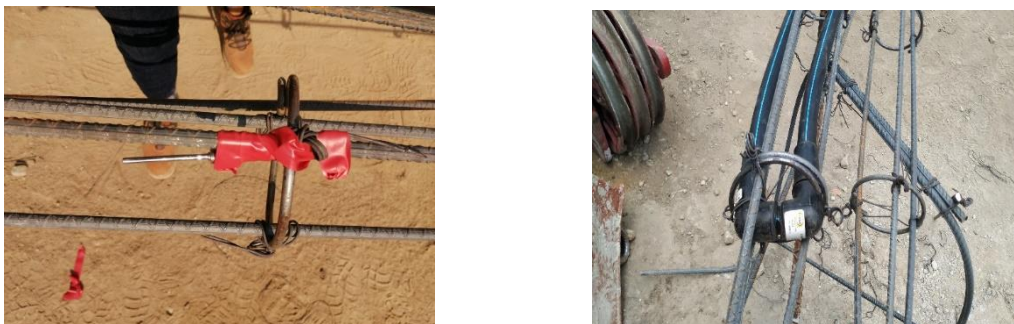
a) Armado rígido para el pozo de prueba y pozo de observación; b) Vista en corte del arreglo *in situ* del pozo de prueba y pozo de observación.
